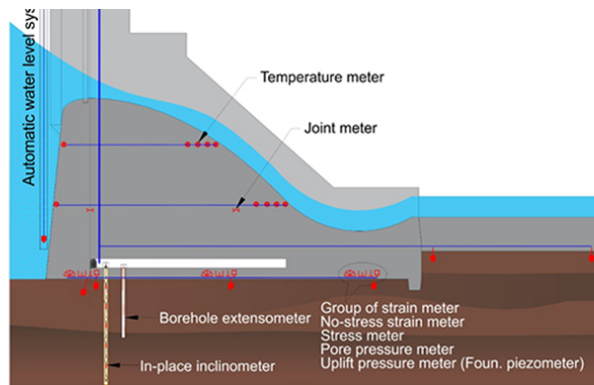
Esquema de Instrumentação Típico – Barragem de Betão: Perfil longitudinal de uma barragem de betão e instrumentação associada. (Adaptado de Encardio-rite, 2021)
